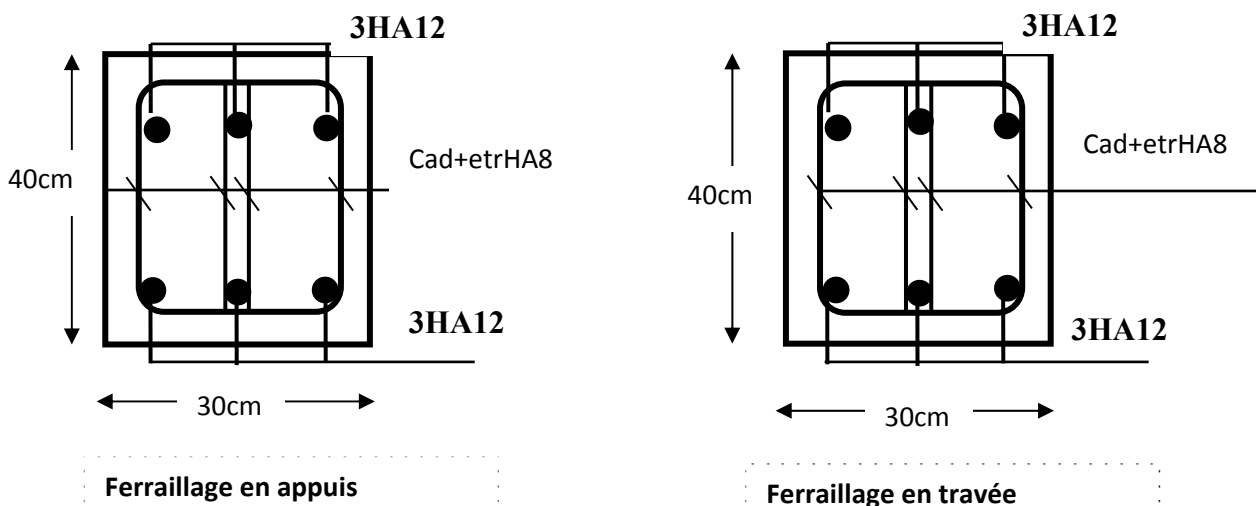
Schéma de ferrailage de la poutre palière du 4^{ème} Type d'escalier.
